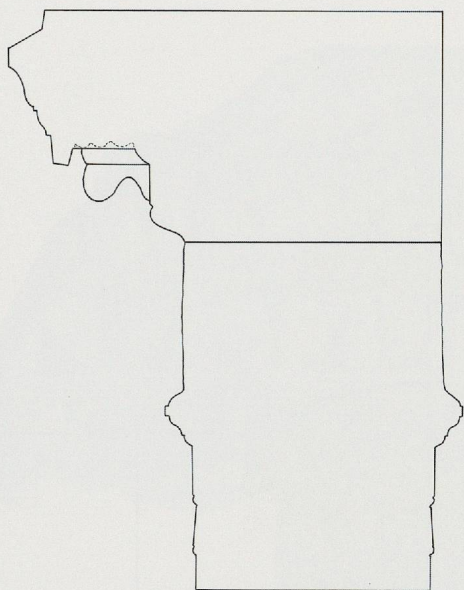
Coupe de l'entablement. Ech. 1:20. (Dessin P. Hauser).
